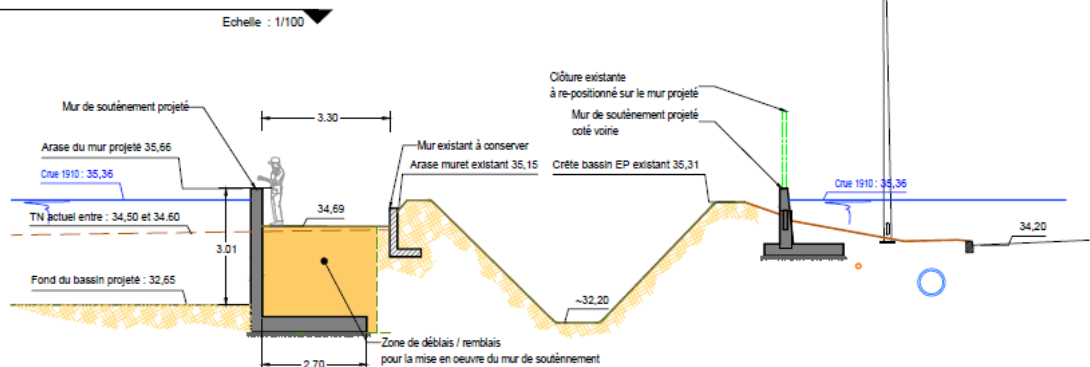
Plan et coupe du mur de soutènement du bassin de compensation
